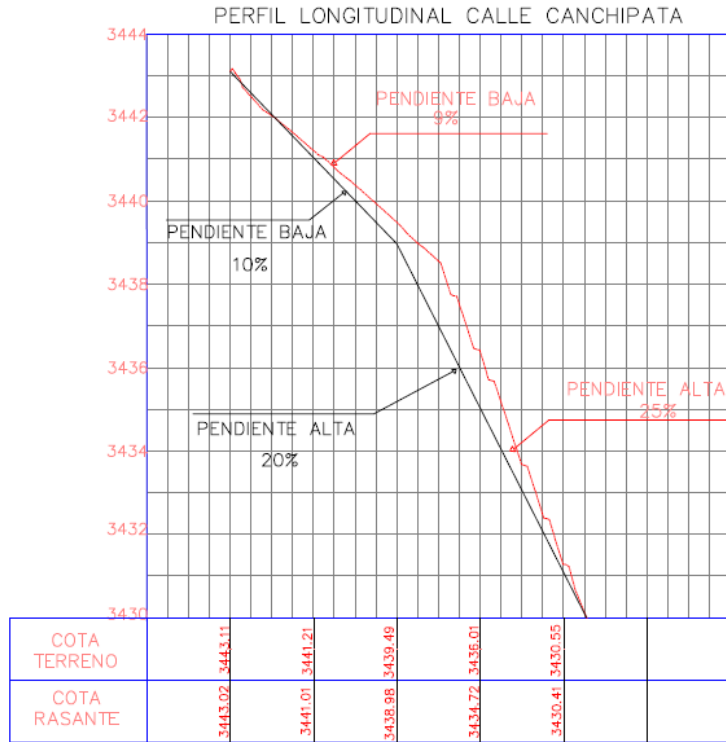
Perfil longitudinal de la propuesta en la calle Canchipata
